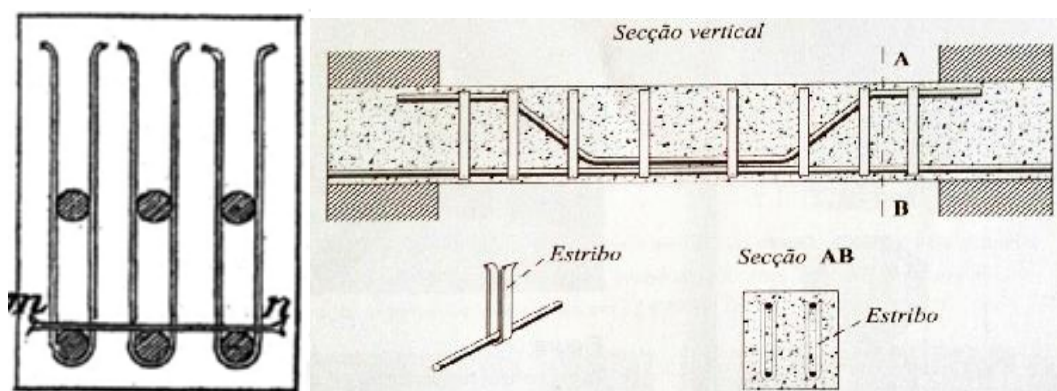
Pormenor da secção transversal de uma viga de BA e outras disposições construtivas (adaptado de J. Appleton, 2013).
